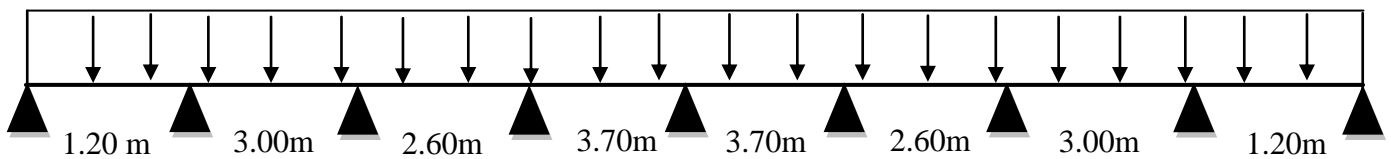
Schéma statique de poutrelle plancher terrasse (type2).
